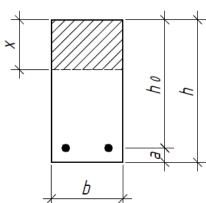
Расчетное поперечное сечение изгибаемого железобетонного элемента прямоугольного профиля с одиночным армированием.
